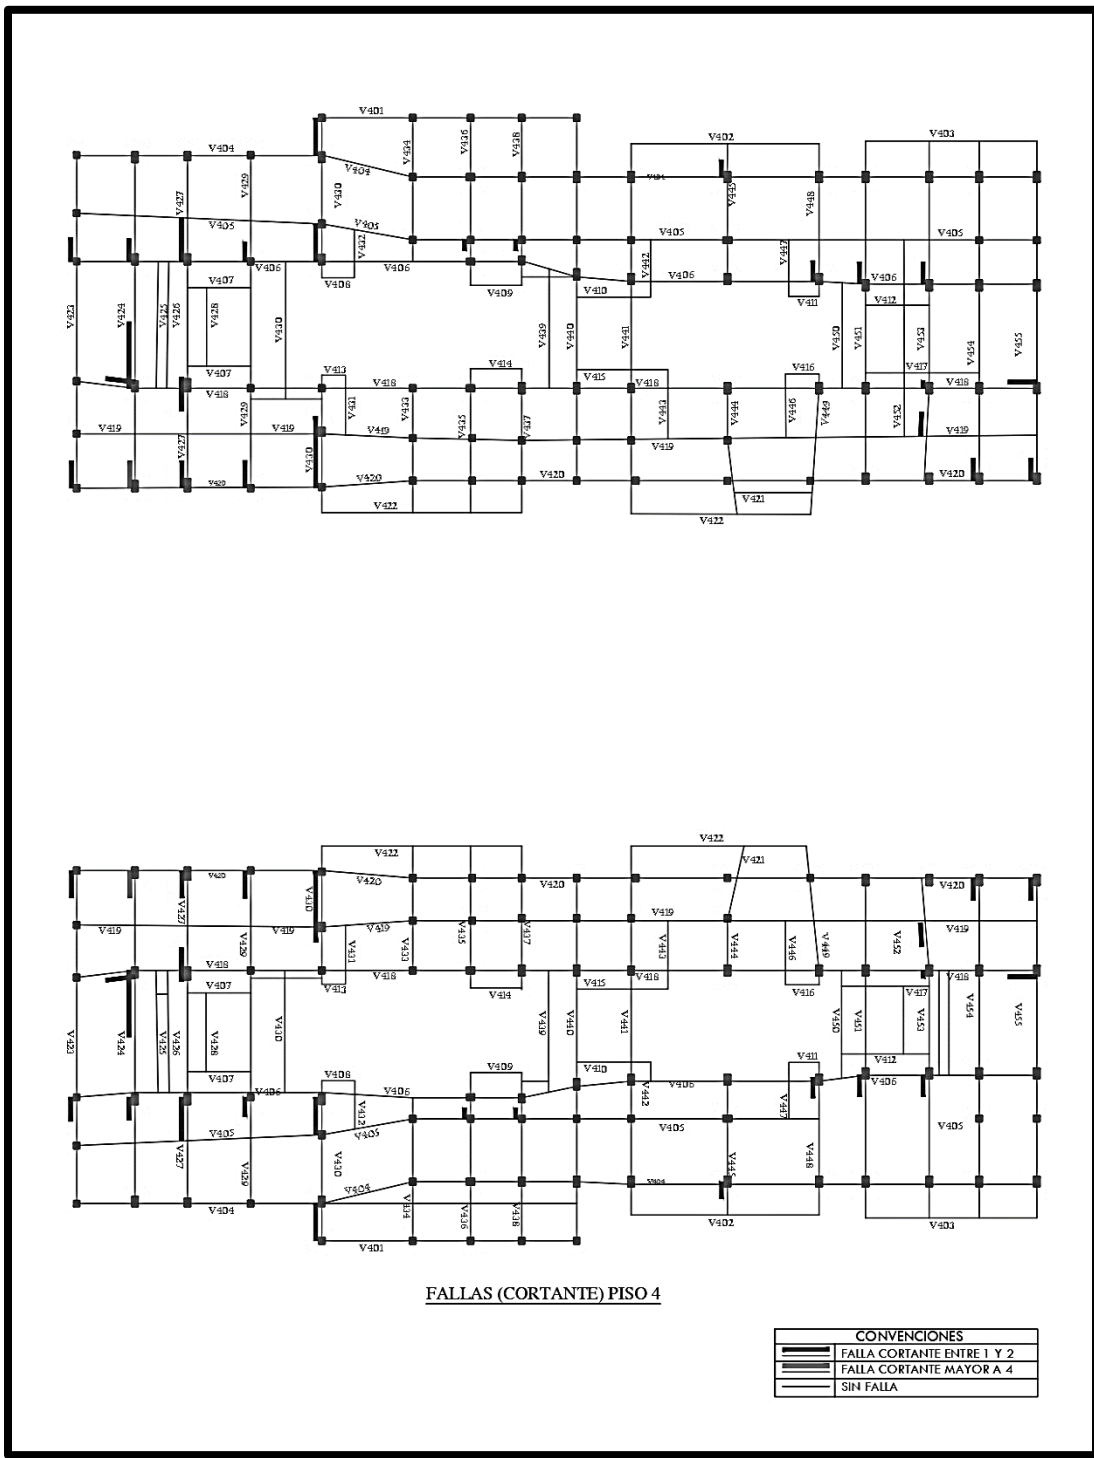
Plano de secuencia de fallas (Cortante) 4 piso. Fuente: Los autores
